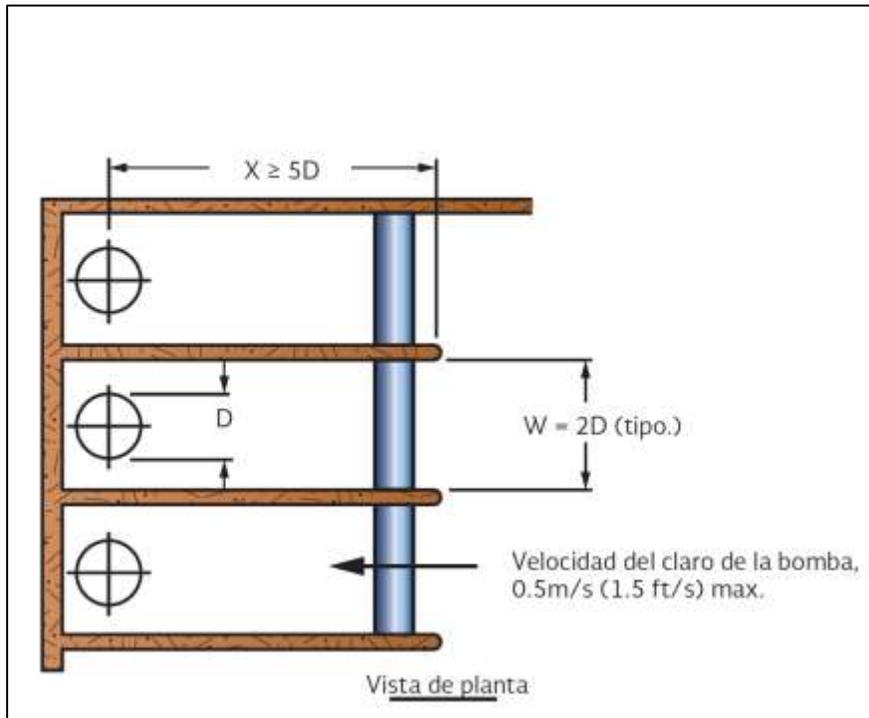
Diseño de la cámara de succión del cárcamo, vista en planta
